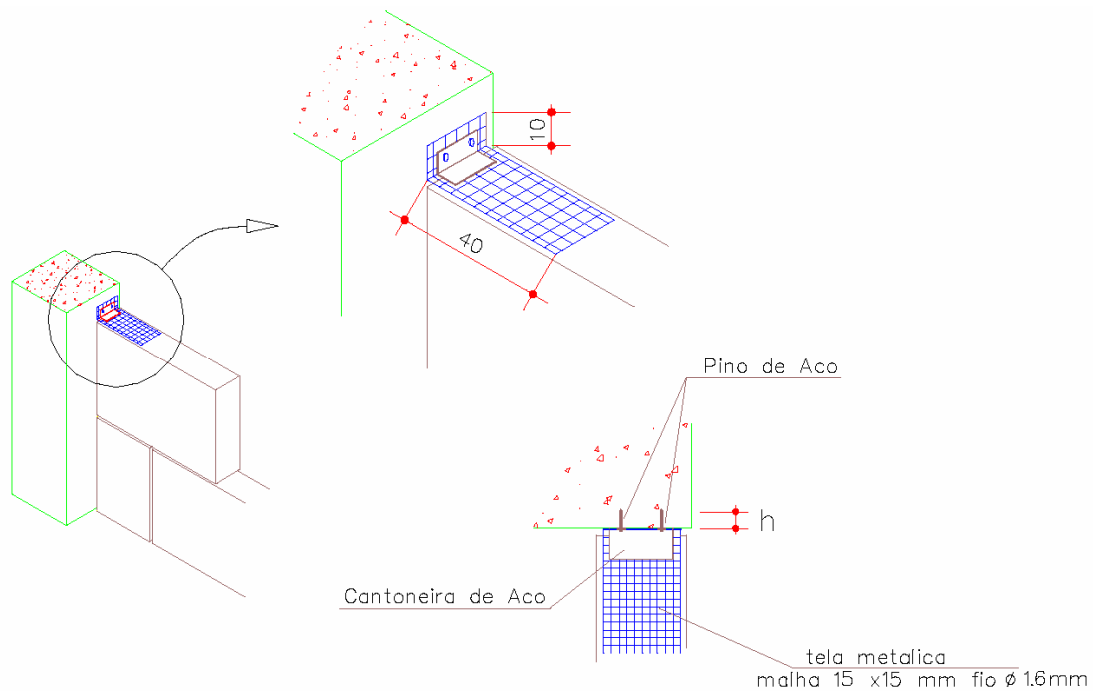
Detalhes de instalação da tela metálica para ligação entre parede e pilar
